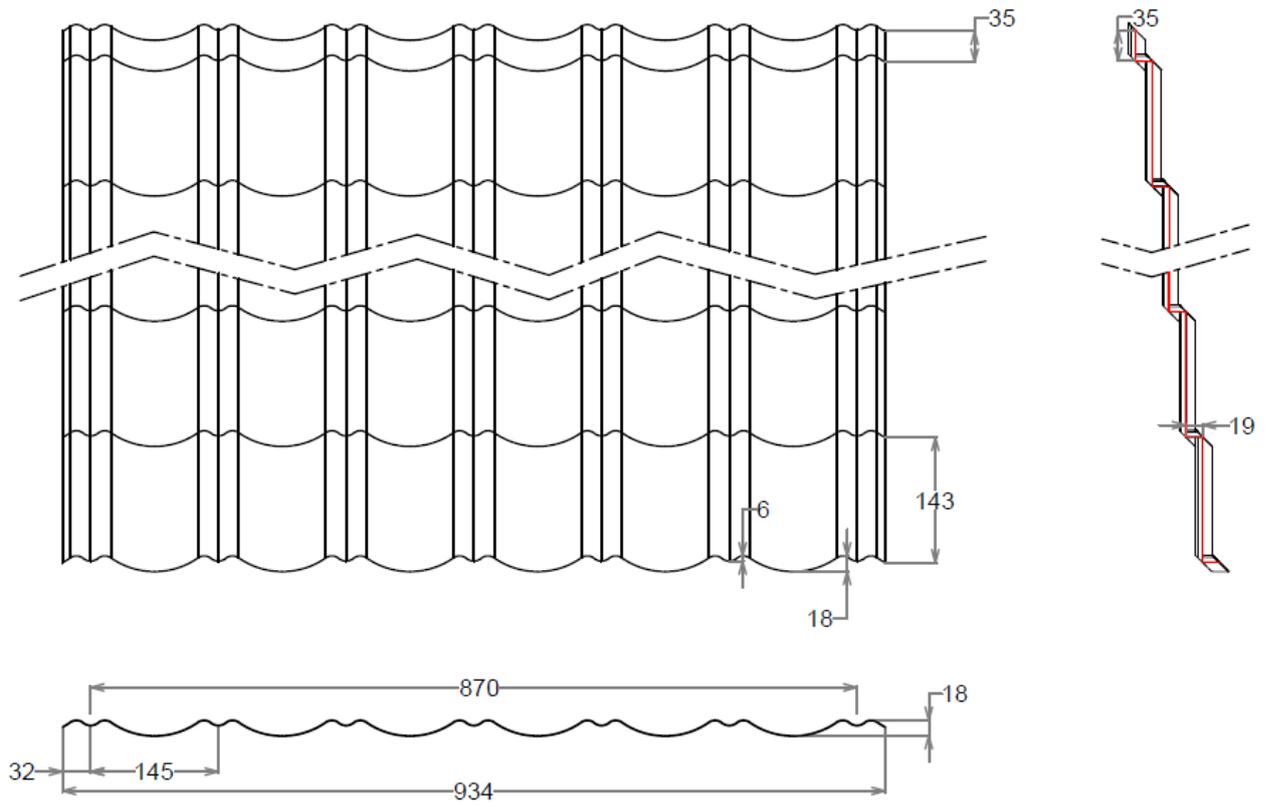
Dimensions TUILE R (exemple largeur utile 870 mm)
